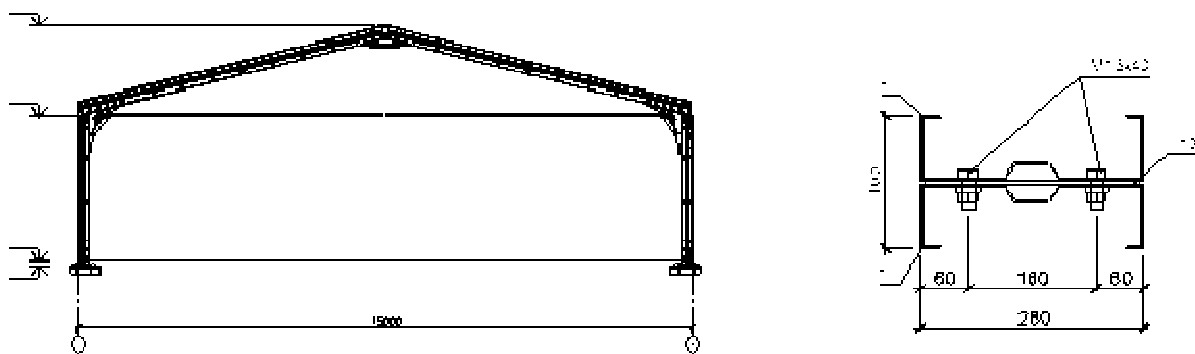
Поперечна рама несучого каркасу і поперечний перетин стойки та ригеля рами.
